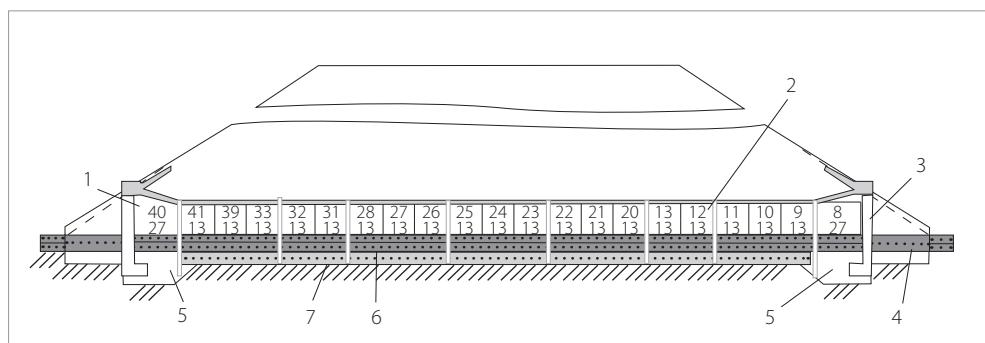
Водопропускная труба: 1 — коническое звено трубы; 2 — звенья; 3 — порталный блок оголовка; 4 — лоток из монолитного бетона; 5 — песчано-гравийная подготовка; 6 — щебеночная подготовка; 7 — блоки фундамента
